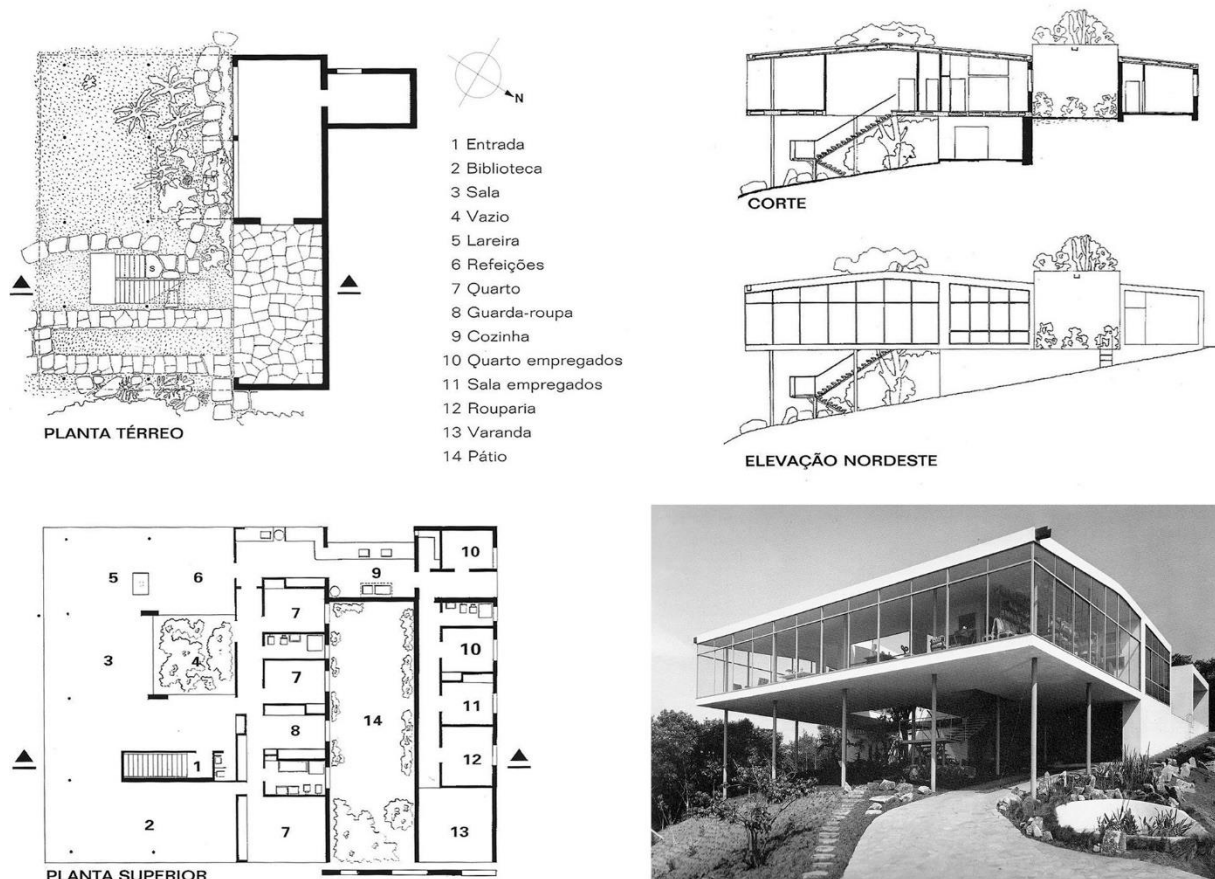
Casa de Vidro, São Paulo. Lina Bo Bardi, 1948-51. Plantas, corte, elevação e vista em 1951.
